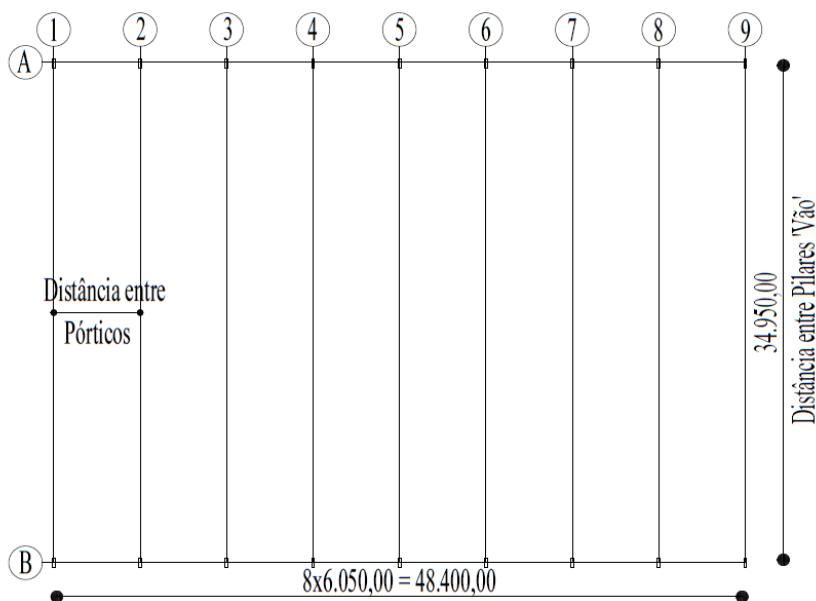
Planta de localização dos pórticos do Módulo esportivo, medidas em mm.
